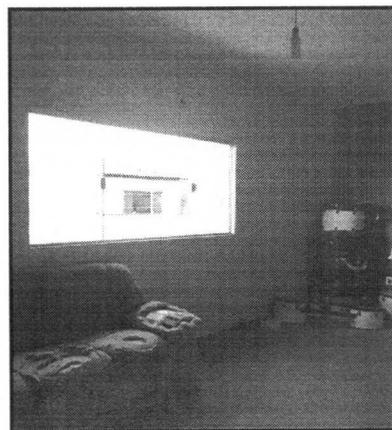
Imagem do Salão de entrada do pavimento superior, com destaque ao piso sem revestimento cerâmico
